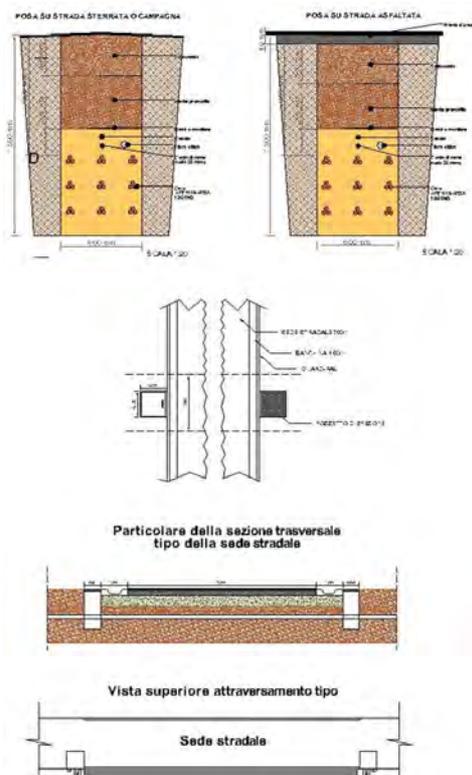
Particolare sezione tipo cavo interrato M.T. e particolari della sezione stradale
